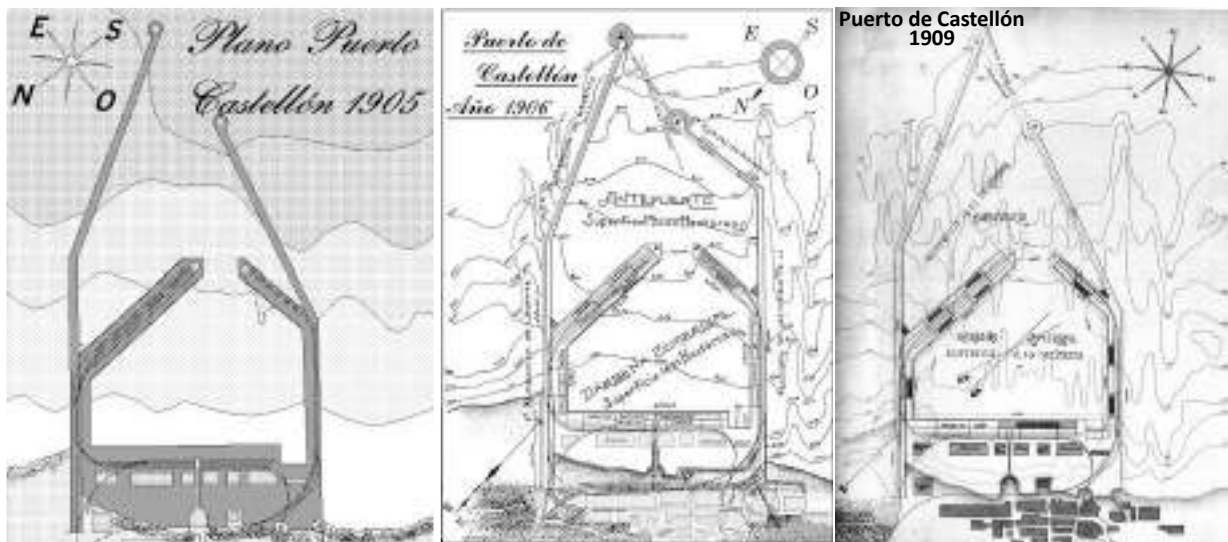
Plano del Puerto de Castellón (1905-1906-1909)
